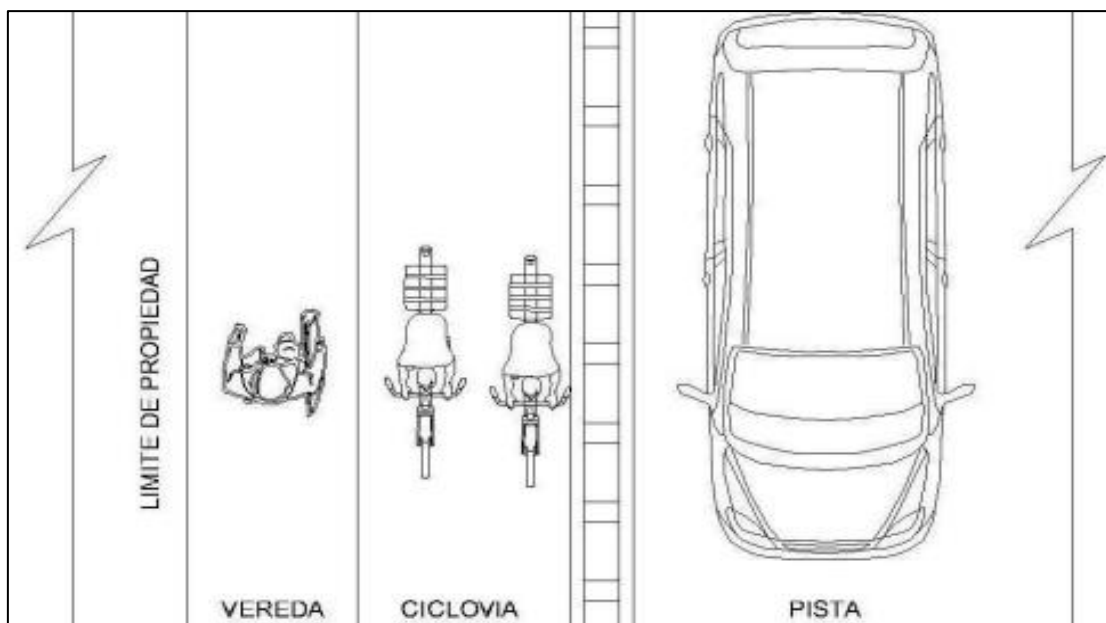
Ejemplo de elemento de segregación (Tachones entre dos franjas pintadas de un ancho de 10 cm) – Vista planta.
